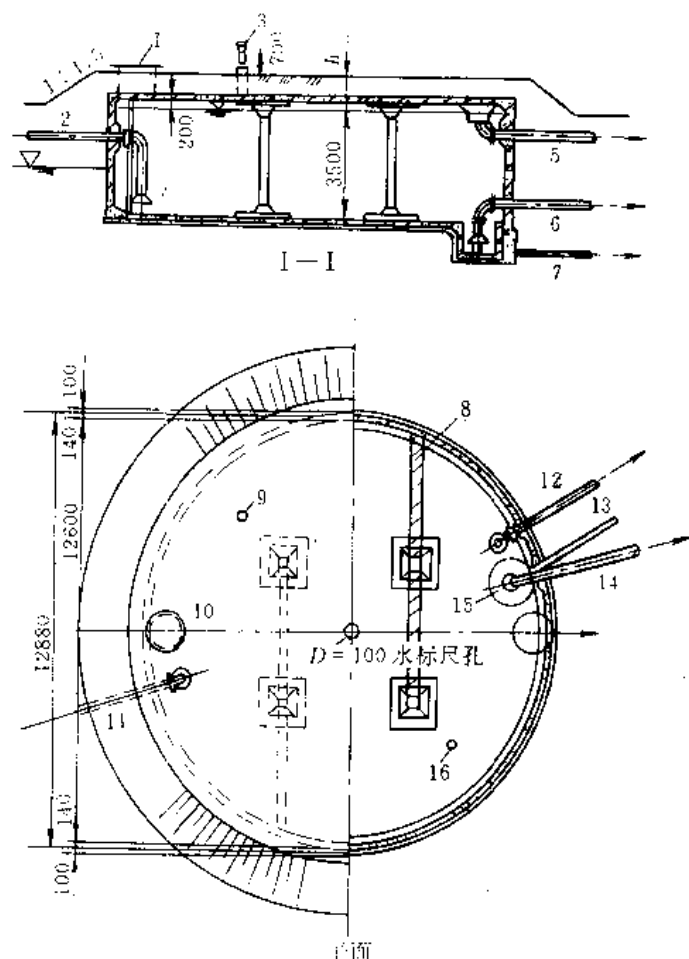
400m³ 圆形钢筋混凝土清水池
